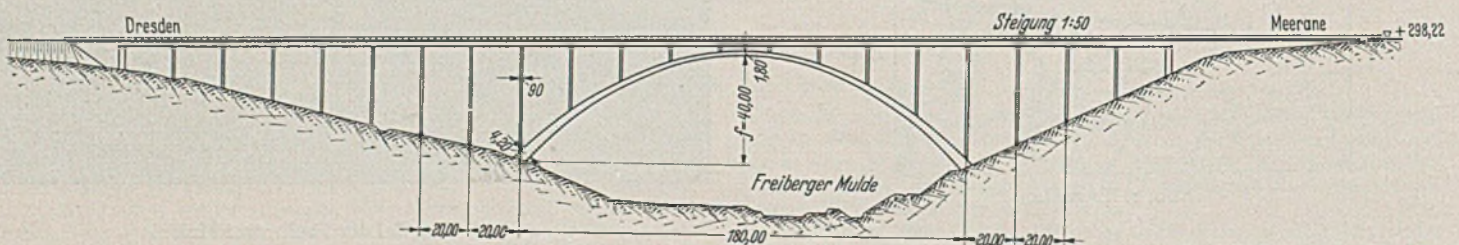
Ausschreibungsentwurf in Eisenbeton.
